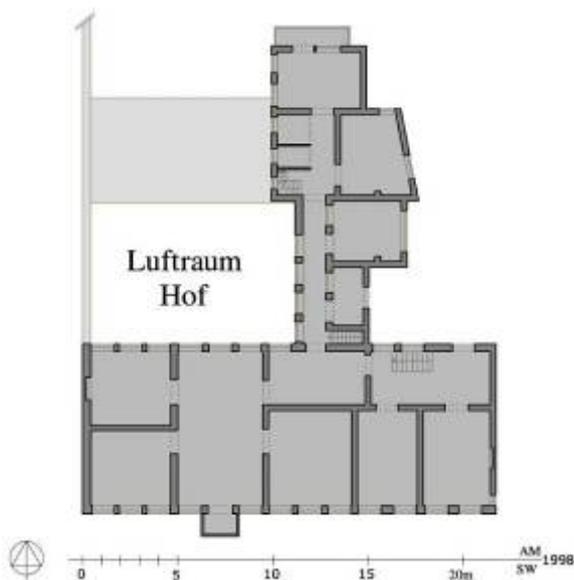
Bayt Bizm, Grundriss 1. OG
